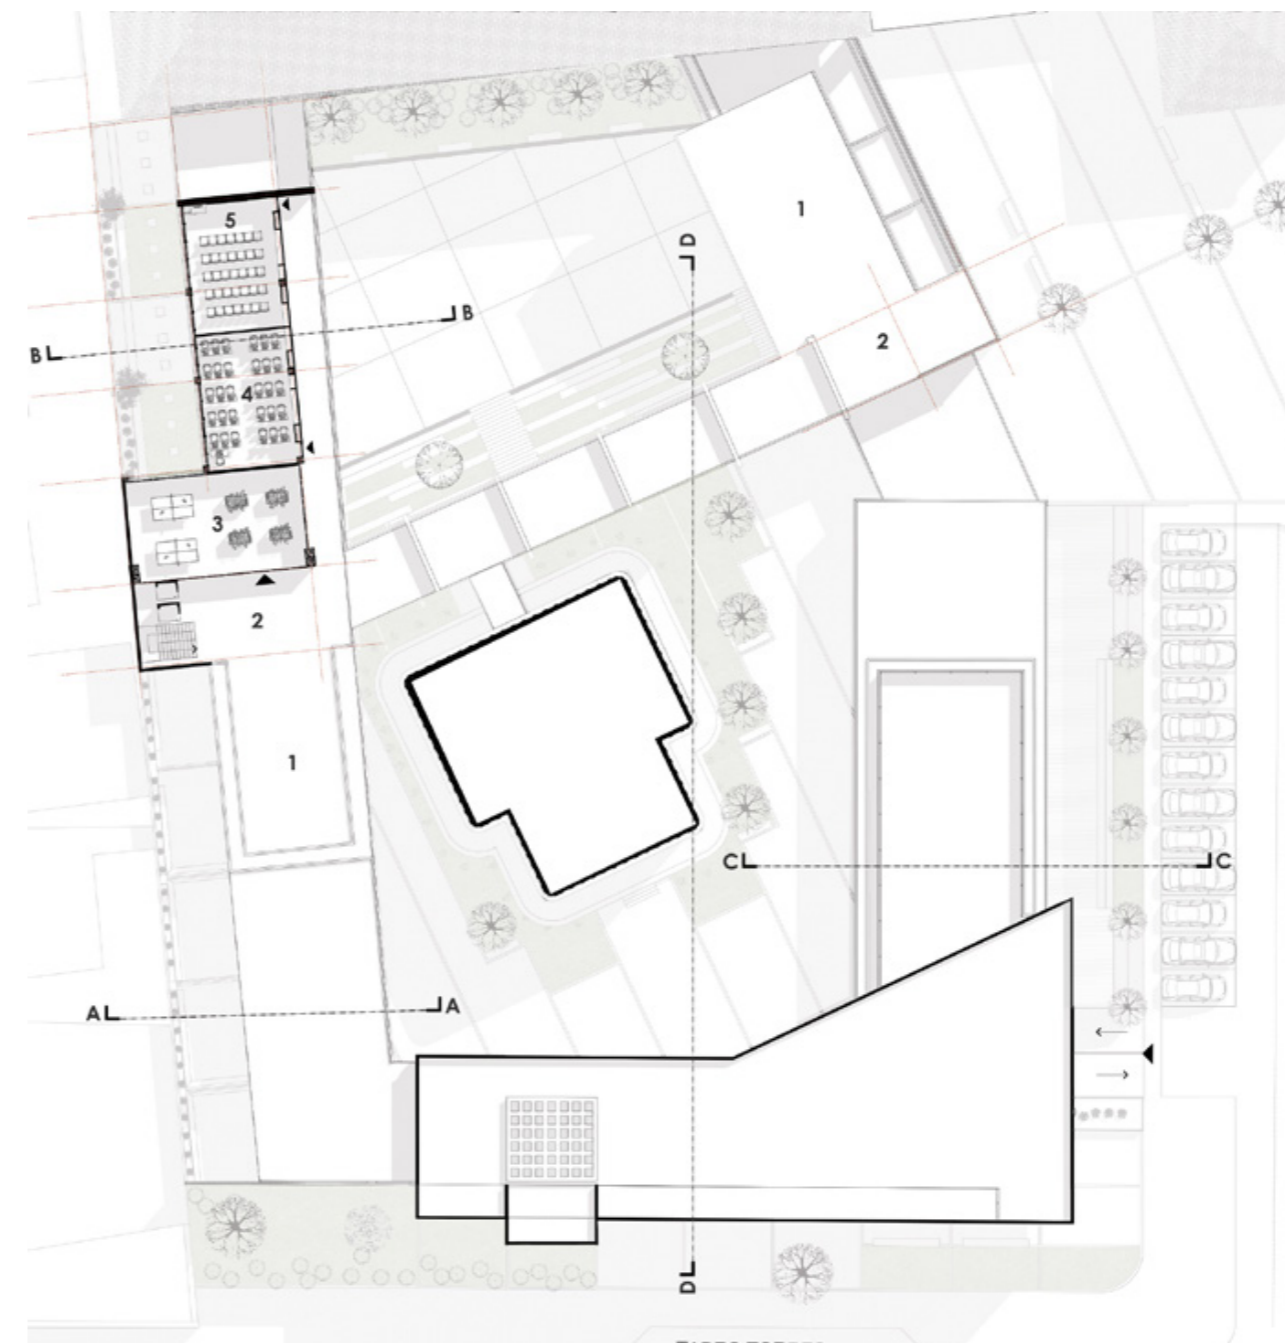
Propuesta de 1ra Planta alta | Fuente: Elaboración propia
